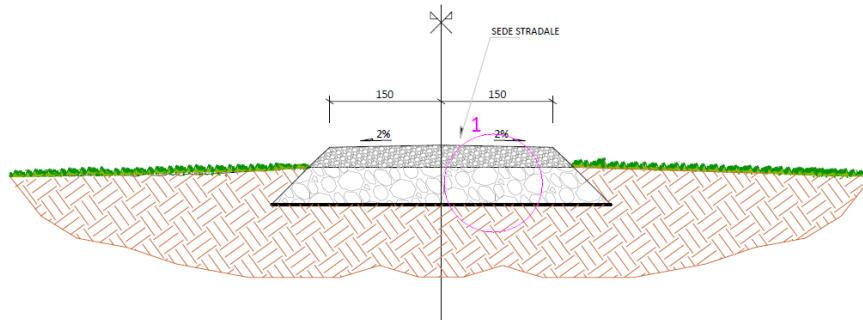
Estratto elaborato R.10 (Planimetria viabilità interna parco)
